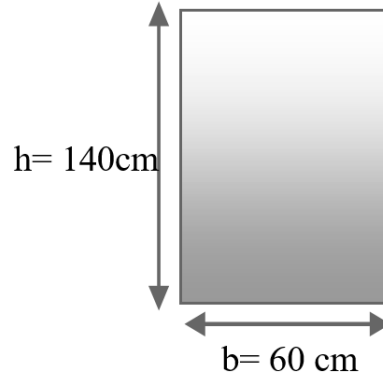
Dimensions du section de la poutre principale(60x140)
